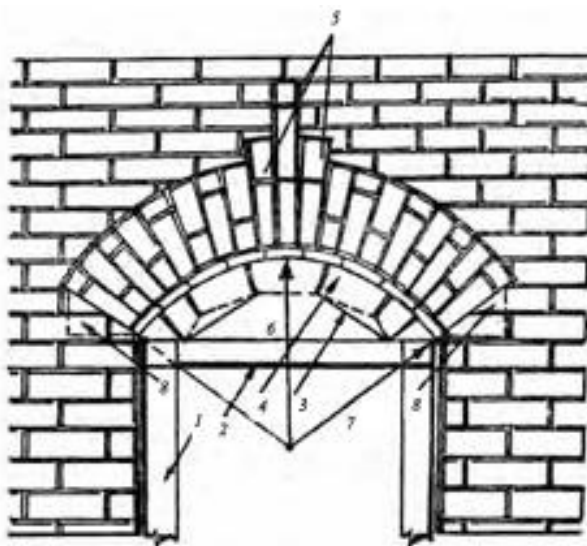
Конструкция полу циркулярной арочной перемычки: 1 — стойка; 2 — прогон; 3 — кружало; 4 — опалубка; 5 — замковые кирпичи; 6 — ось арки; 7 — радиус арки; 8 — пята. Кирпичные перемычки выкладывают по предварительно установленной опалубке, которая снимается только после полного схватывания раствора (Рис. 4.).
